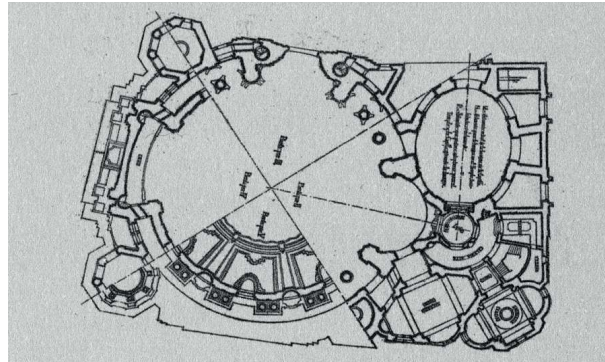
Planta del proyecto de Vicente Traver Tomás.
